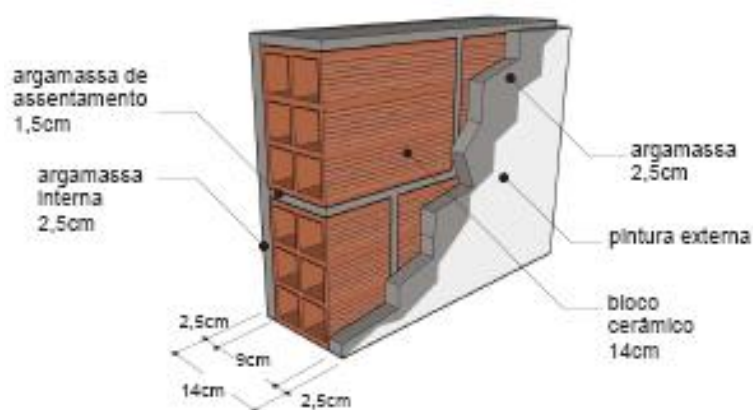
CARACTERÍSTICAS DA PAREDE DE ALVENARIA
